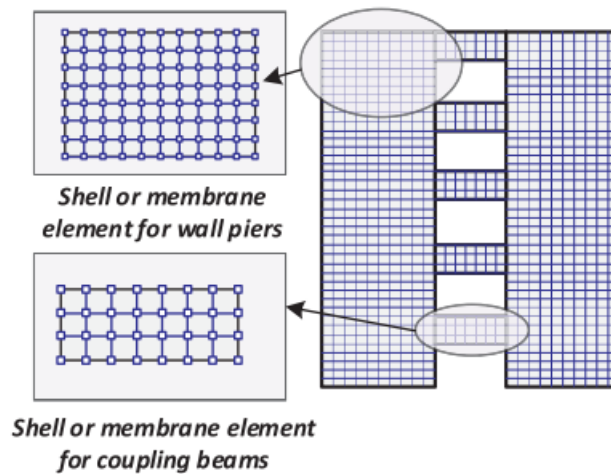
Elementos membrana o shell para muros y vigas de acople [3]
